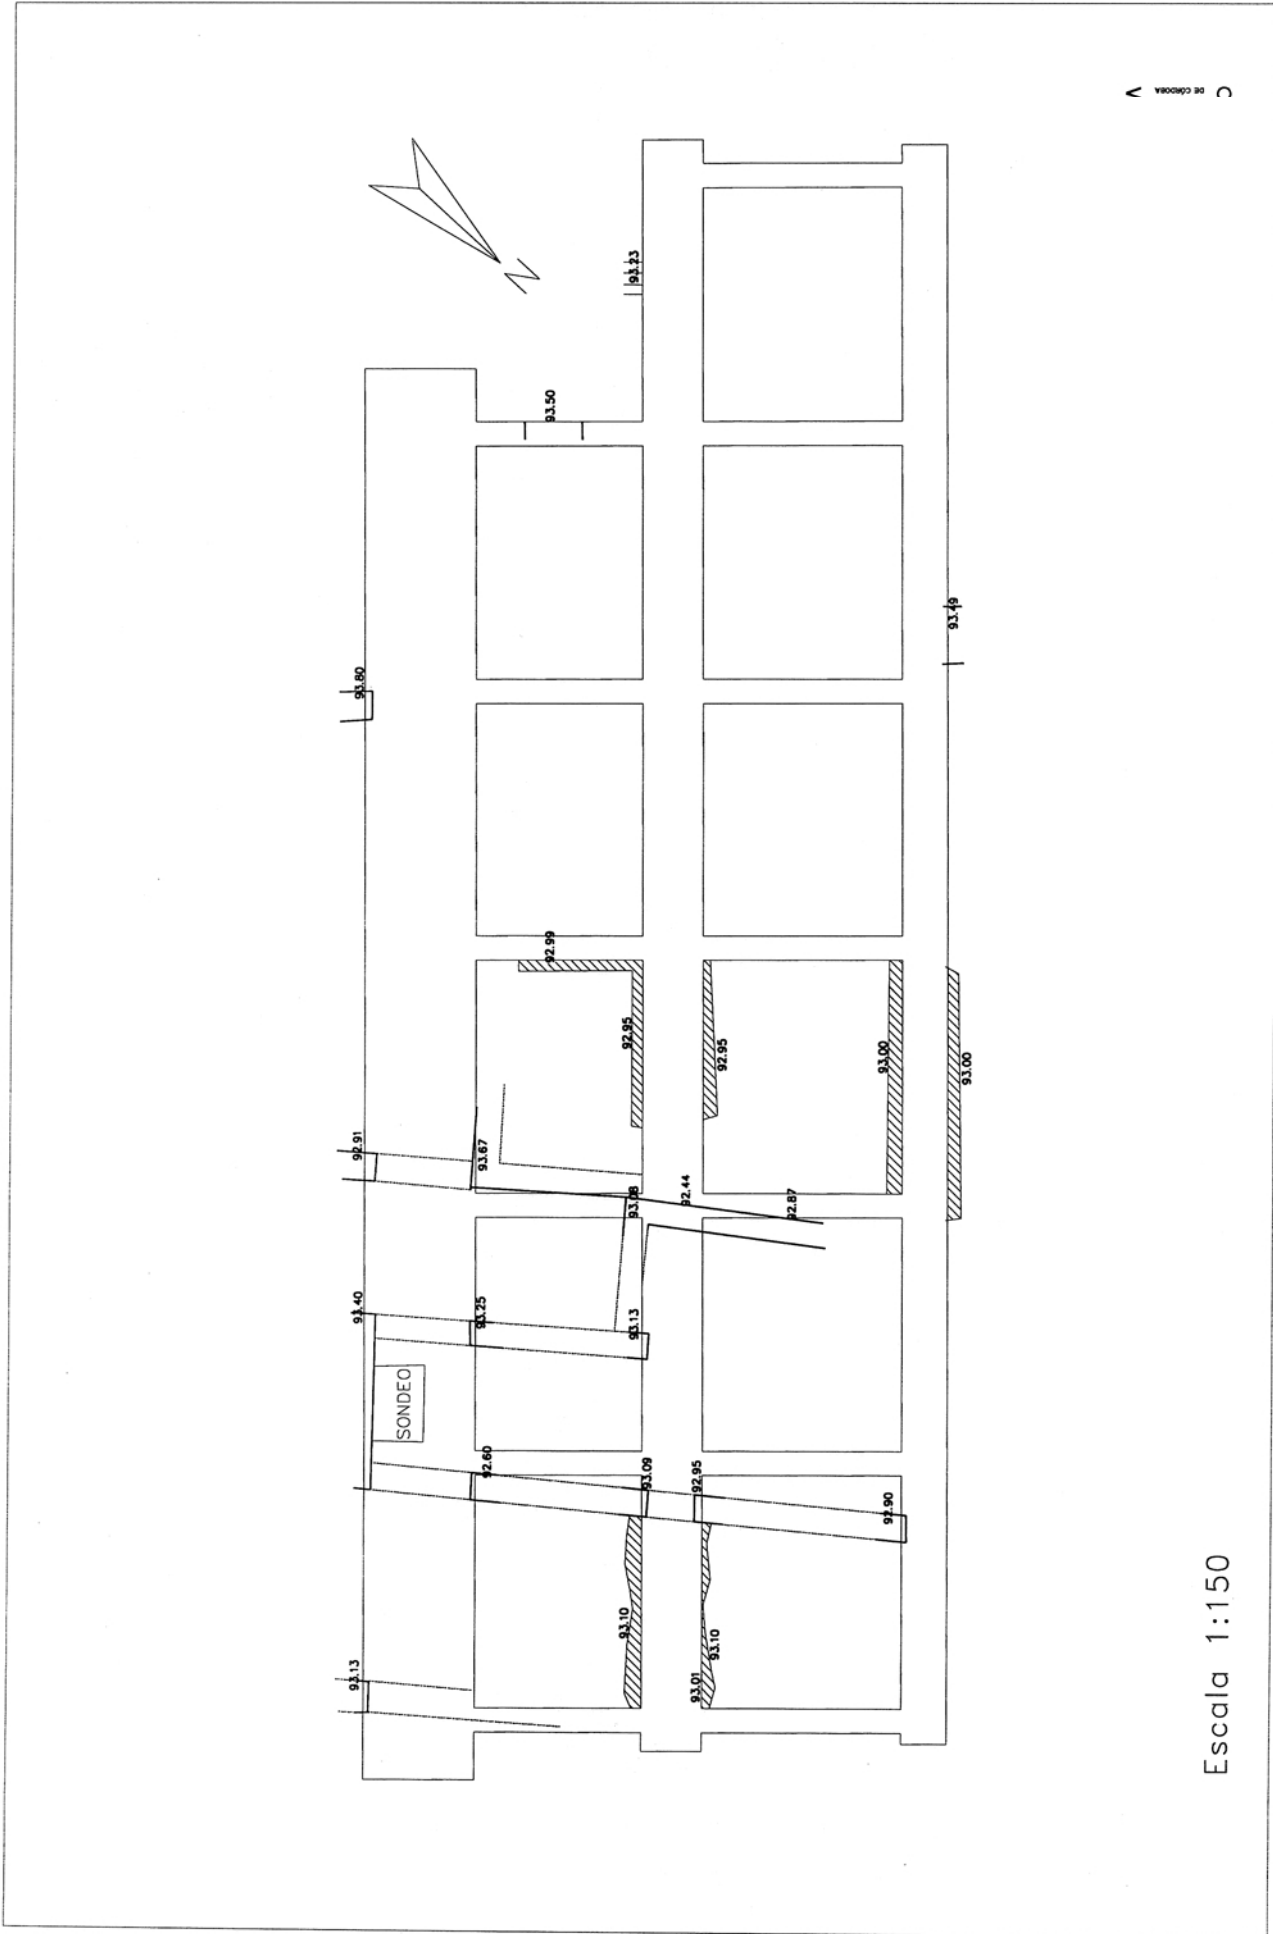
Planta general de Estructuras localizadas en el "Sector de la Marquesina".
